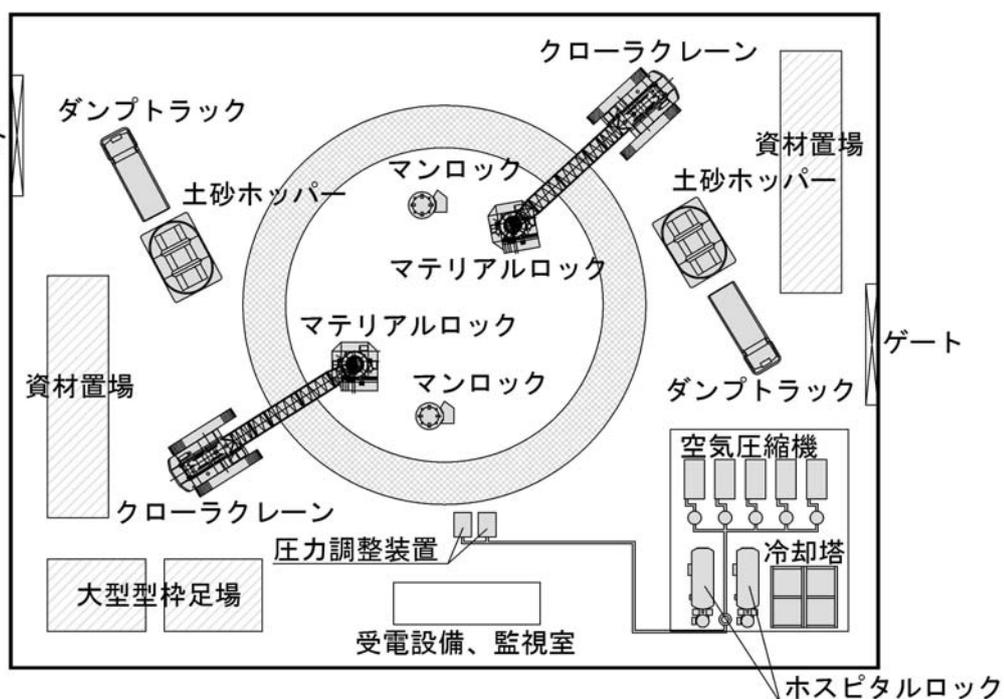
非常口の施工ヤードの概要 (ケーソン工法による非常口施工時)
